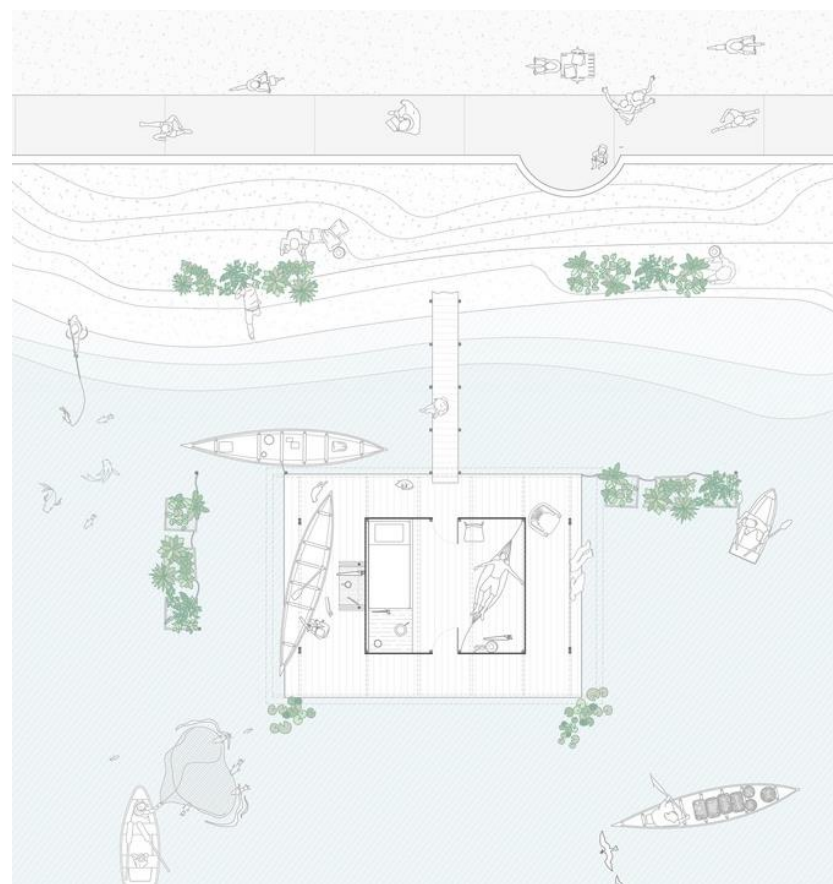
Planta arquitectónica de refugio. Fuente: Natura Futura, s.f.
